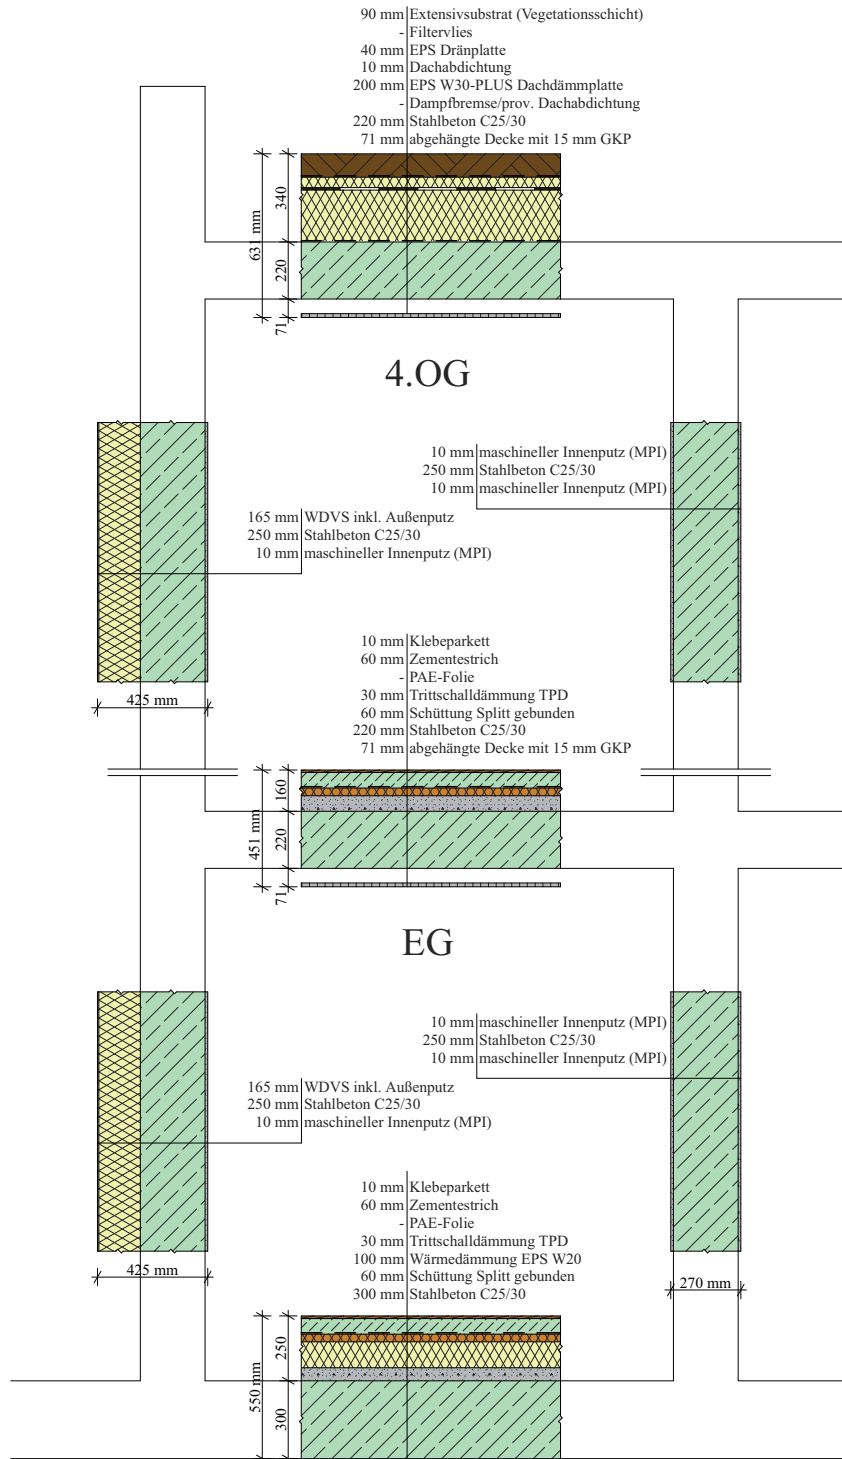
Situierung und Schichtenfolge der Bauteilaufbauten für die Stahlbeton-Massivbauweise
